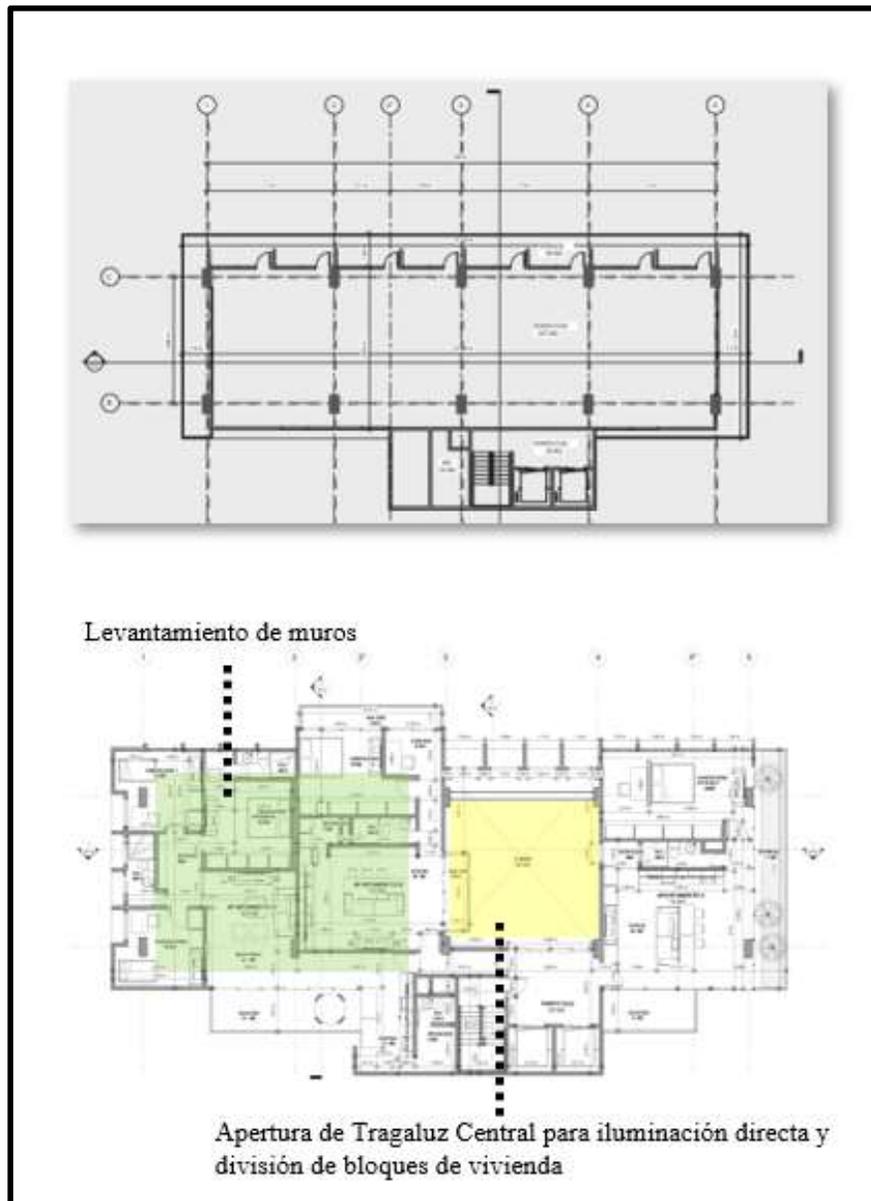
Planta Arquitectónica antes de intervención + Planta Propuesta en área de Departamentos
